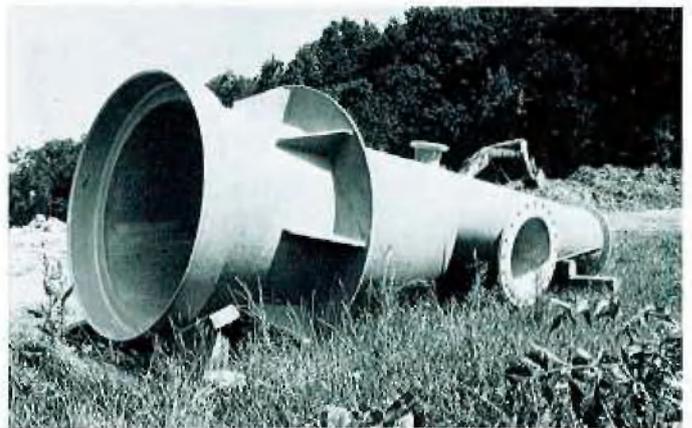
Mit Zementmörtel beschichtetes Formstück
